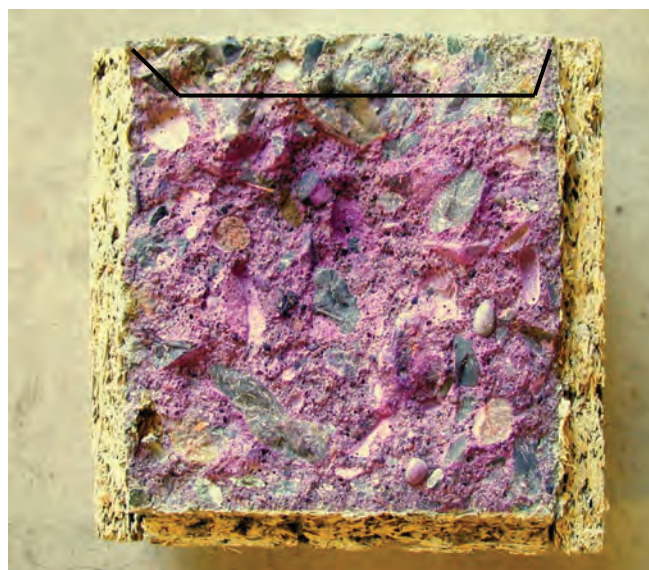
1 コンクリート打放し 写真. 5. 2 木毛セメント板打込み
